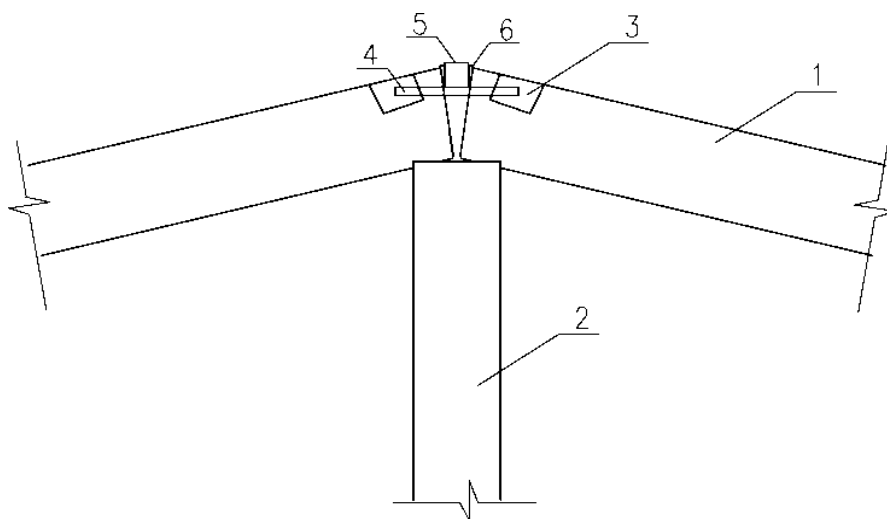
Крепление обрешетки к железобетонной стропильной ноге 1- железобетонная стропильная нога; 2- железобетонная стойка; 3- закладная деталь; 4 - стальная планка - накладка; 5 - коньковый брус; 6 - клинья.
